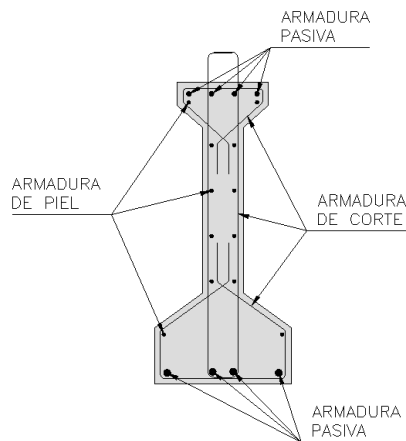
Corte de la viga indicando armaduras dispuestas.
